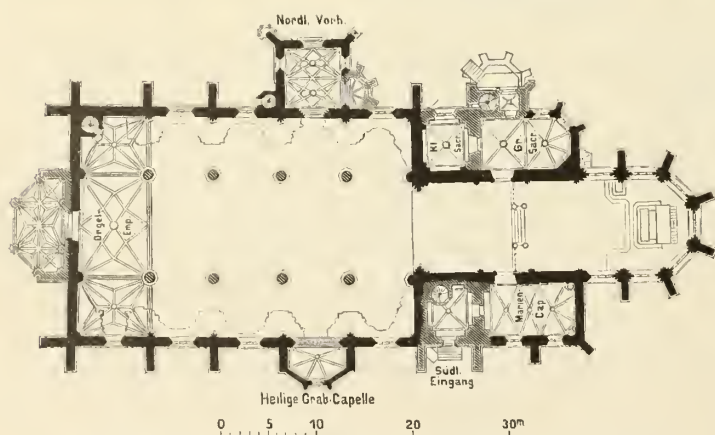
Grundriß. Entwurf des Architekten August Kirstein
